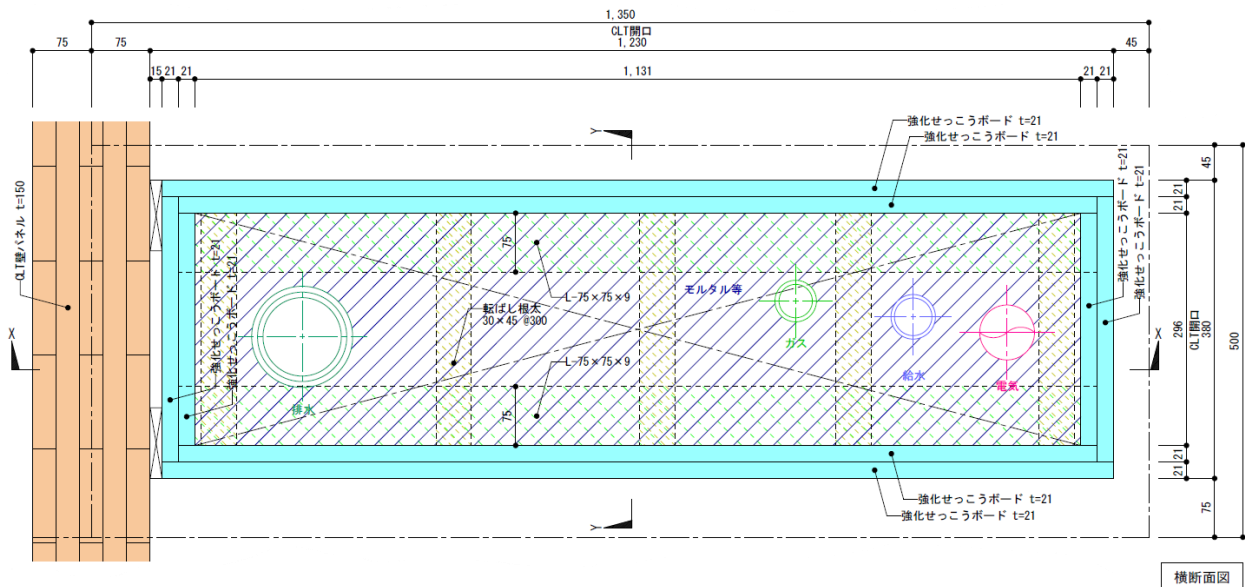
PS部の床貫通孔(大)の納まり例(平面図)
